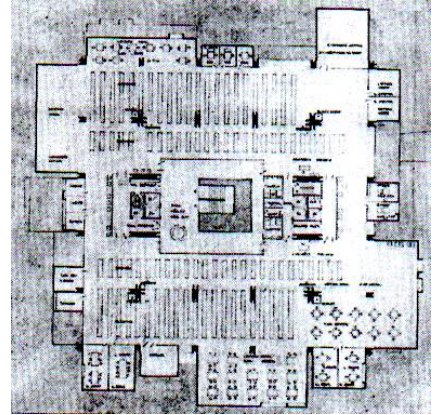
Planta tipo Biblioteca da Bahia, 1968.
